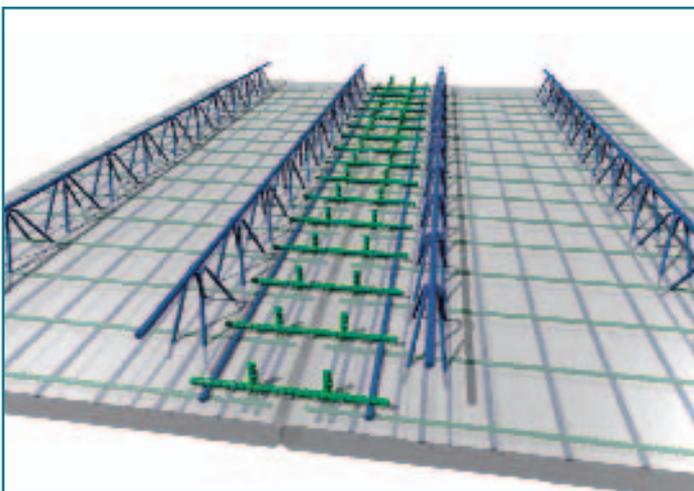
Соединение внапуск высокоэффективных комбинированных стержней арматуры при стыковке сборных железобетонных конструкций.
